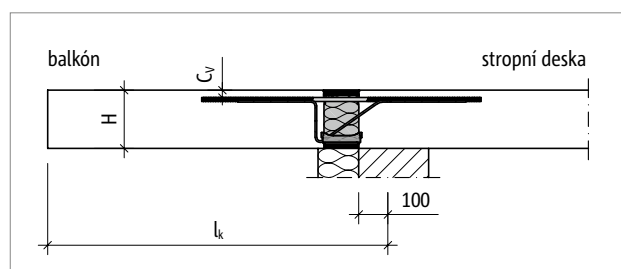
Schöck Isokorb® CXT typ KL: Statický systém
